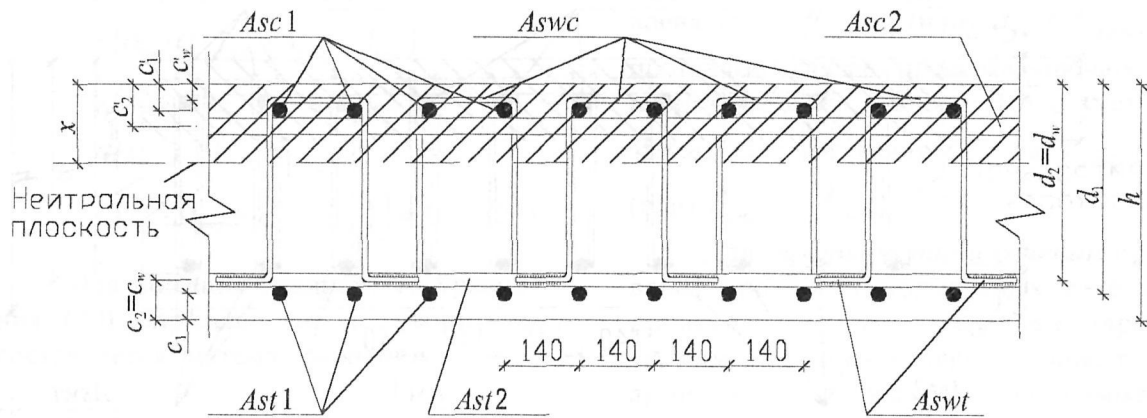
Фрагмент поперечного армирования шестиугольной железобетонной плиты с расположением сжатой зоны в верхней части сечения (сечения 1-1 и 2-2)
